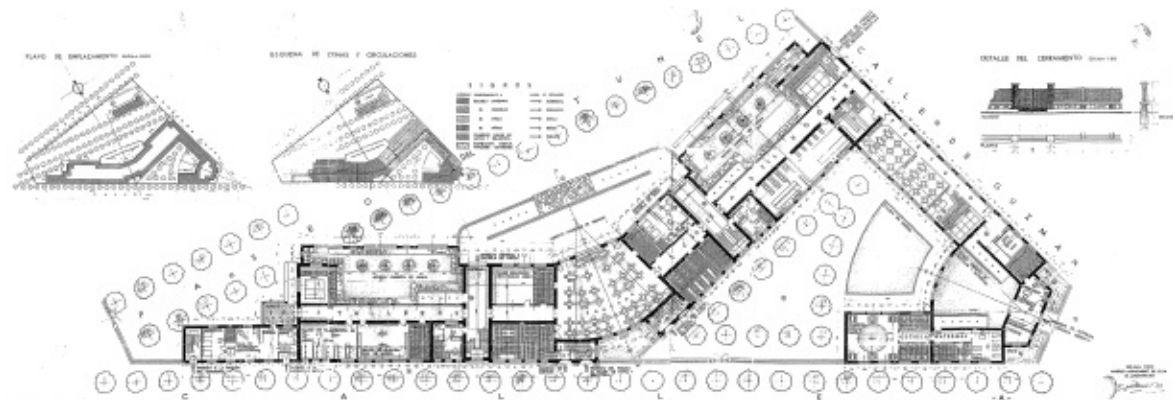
Grupo escolar conmemorativo Gumerindo de Azcárate en León (1934). Planta baja. Arq.: Guillermo Diz
